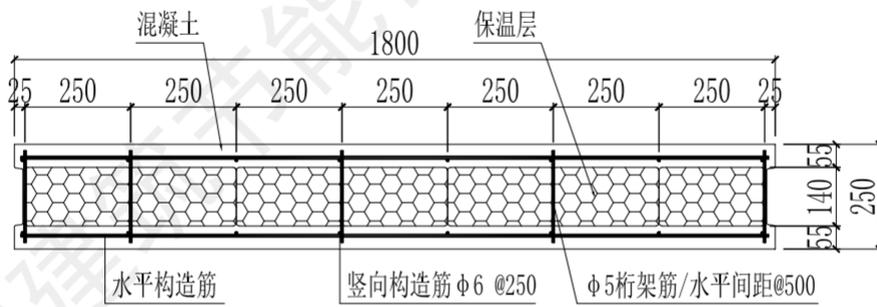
(c) 无肋非承重自保温墙体横截面二维平面图
